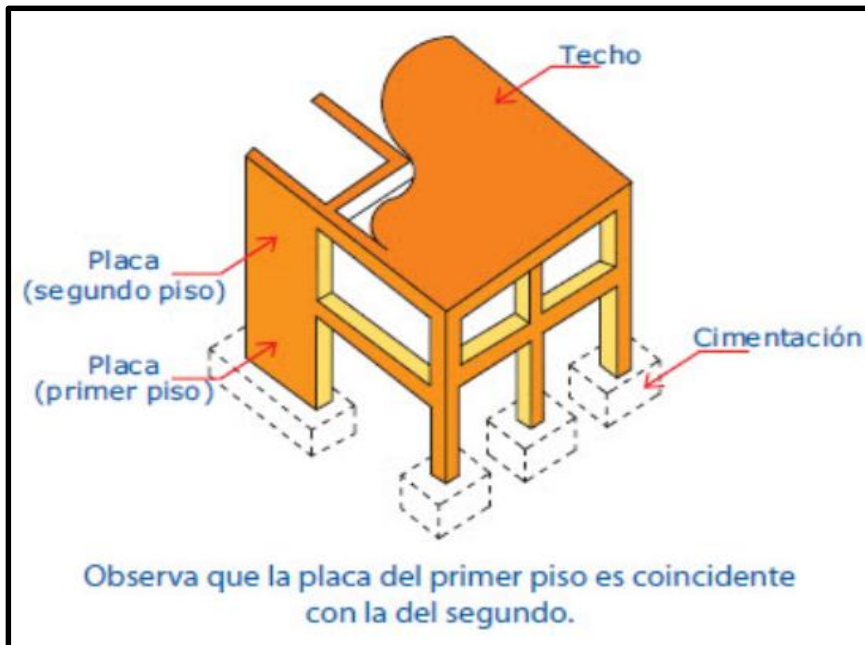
Edificación de dos pisos con placa de concreto armado. Fuente: Aceros Arequipa
